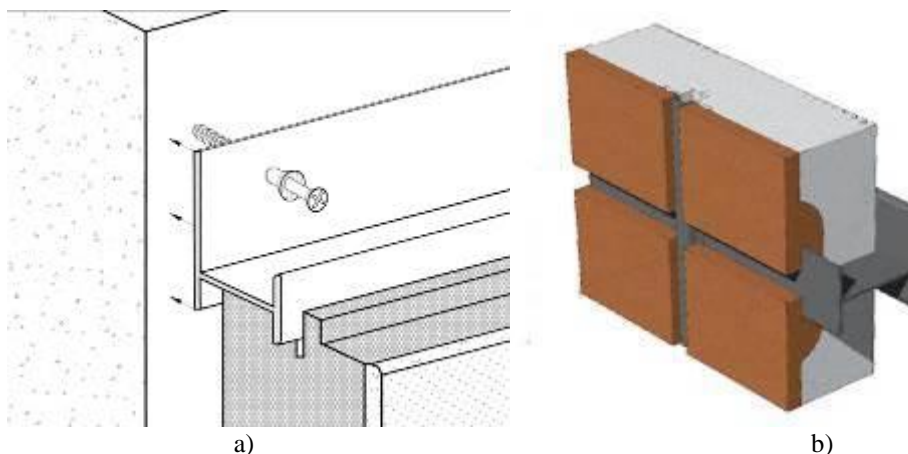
Sistemas de painéis de fachada existentes no mercado: a) ligação ao isolamento, b) ligação ao revestimento [2,4]
